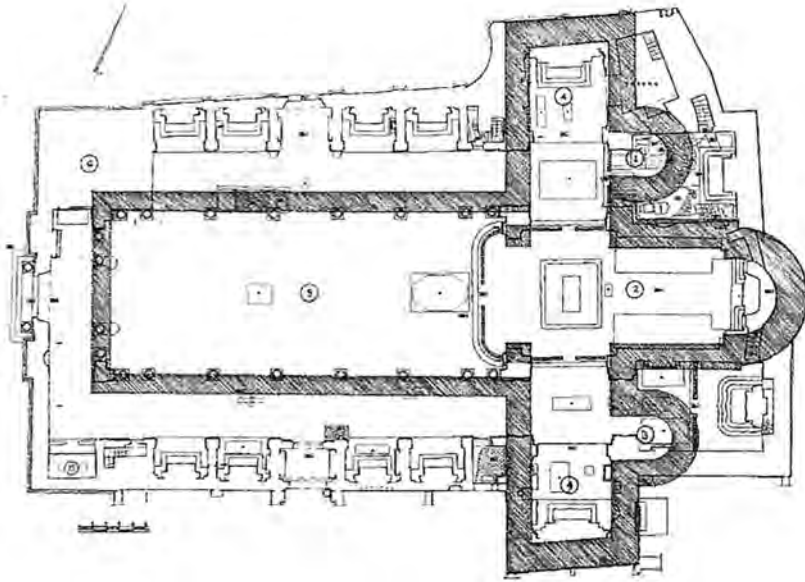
Mazara, cattedrale: ricostruzione della pianta originaria (FILANGERI 2003).
